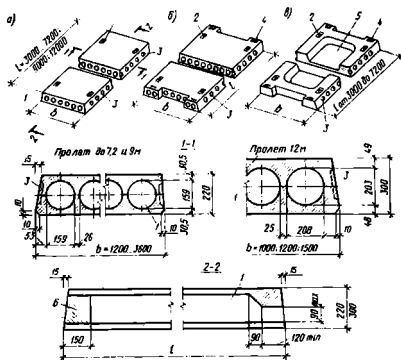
Плиты железобетонные многопустотные для перекрытий жилых и общественных зданий:
